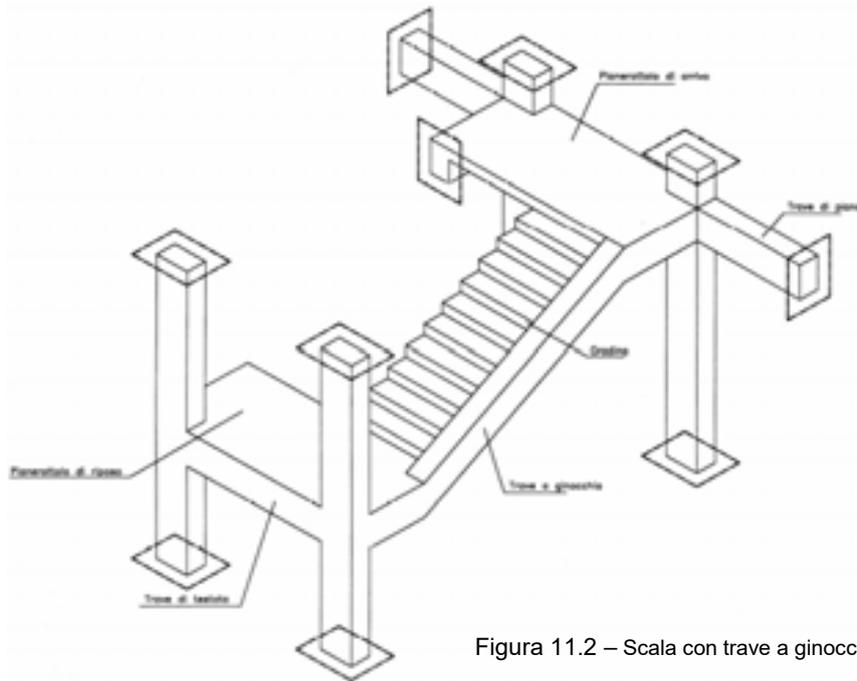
Scala con trave a ginocchio e gradini a sbalzo
